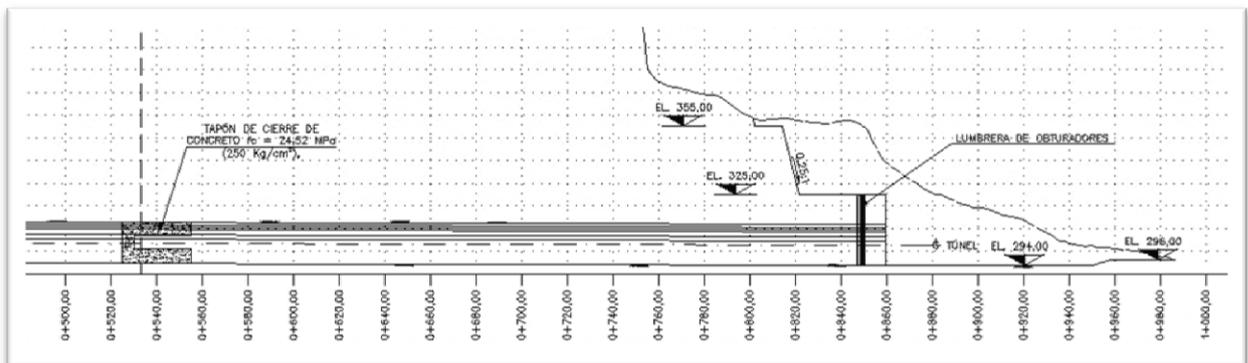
Perfil detalle de taponamiento y lumbrera de obturador –T2
